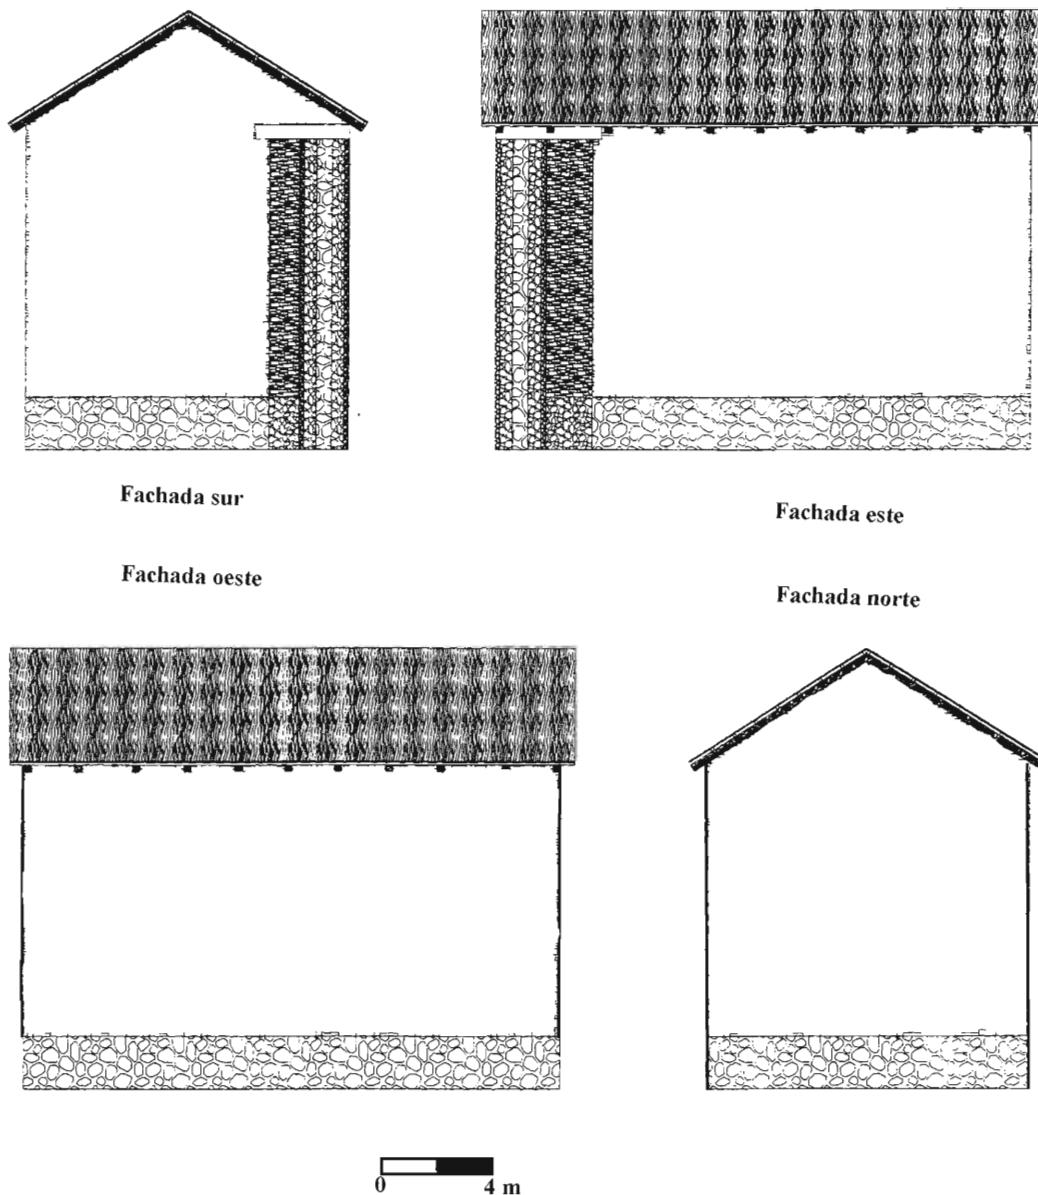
Reconstrucción fachadas con cubierta a dos vertientes (J. Pla).
